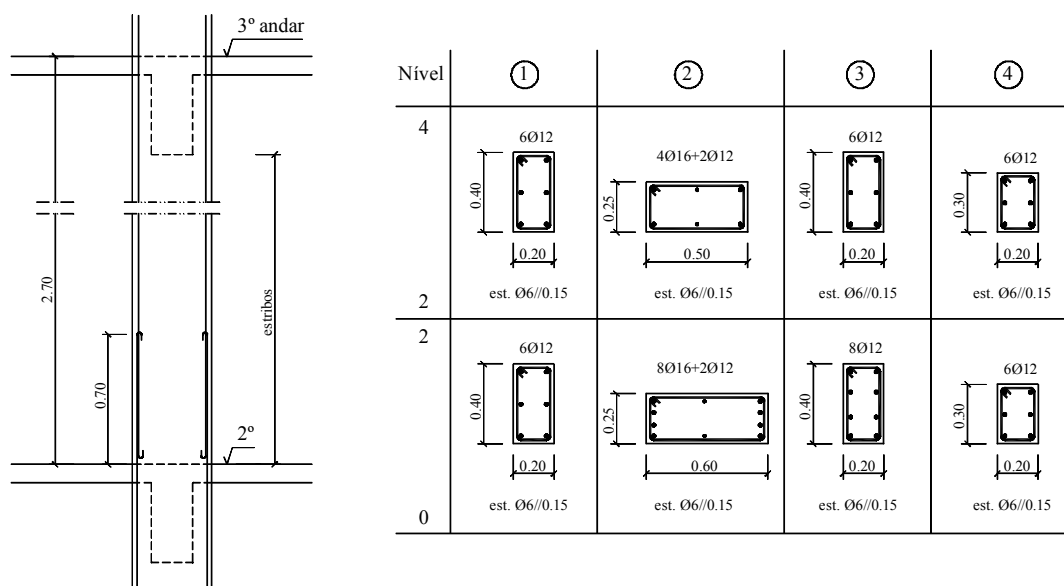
Detalhes da armadura dos pilares do pórtico “ICONS” (Carvalho et al., 1999).
